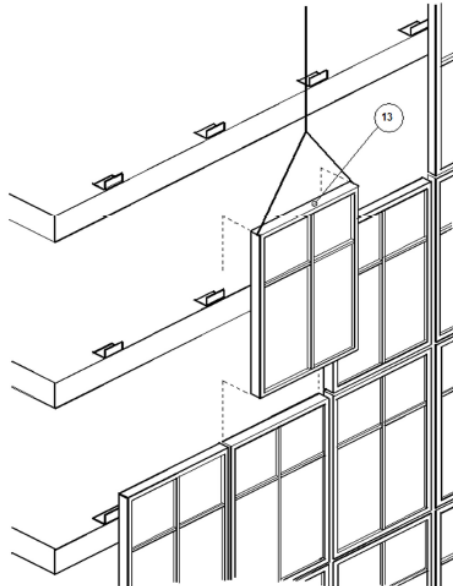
Prinzipskizze einer Elementfassade (Quelle: DIN EN 13119)
